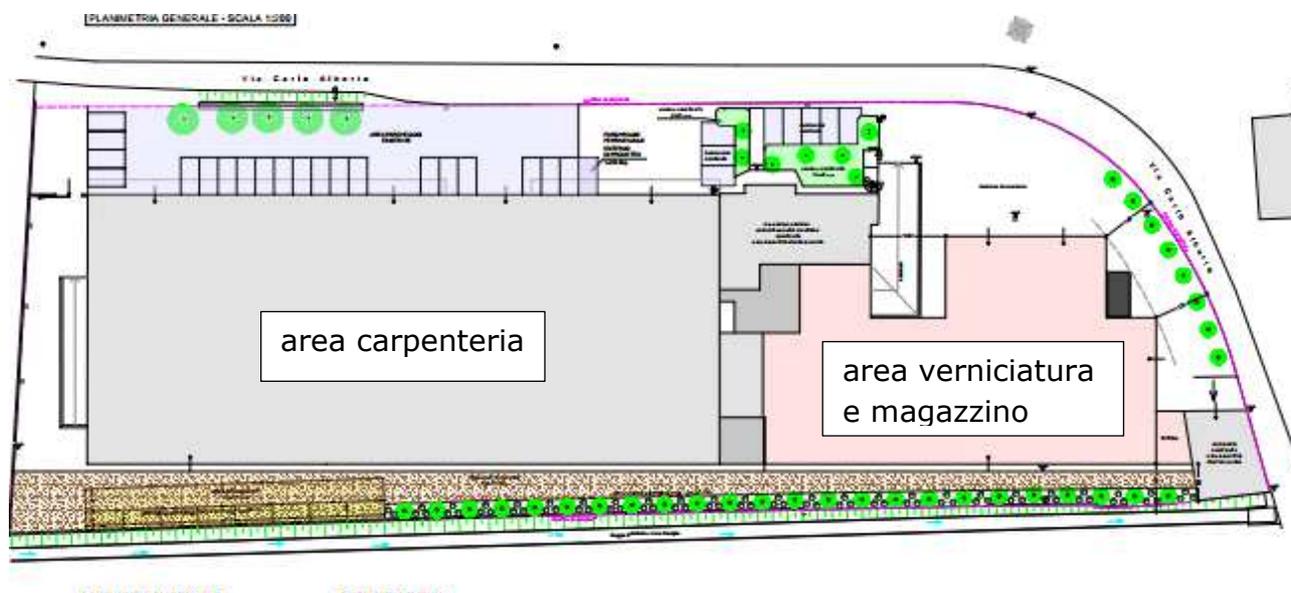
planimetria POST-OPERAM (Area ROSSA)
